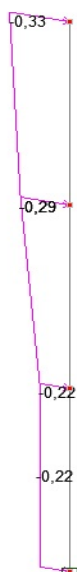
Схема приложения ветровой нагрузки к расчетной схеме 2
